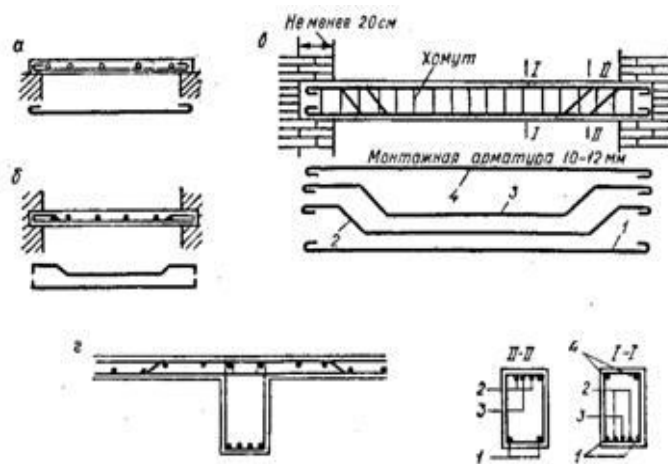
Прутковая арматура в плитах и балках: а и б - в плитах, в - в балках, г - в монолитных перекрытиях. /-/ и //--// - в поперечном сечении балок.
